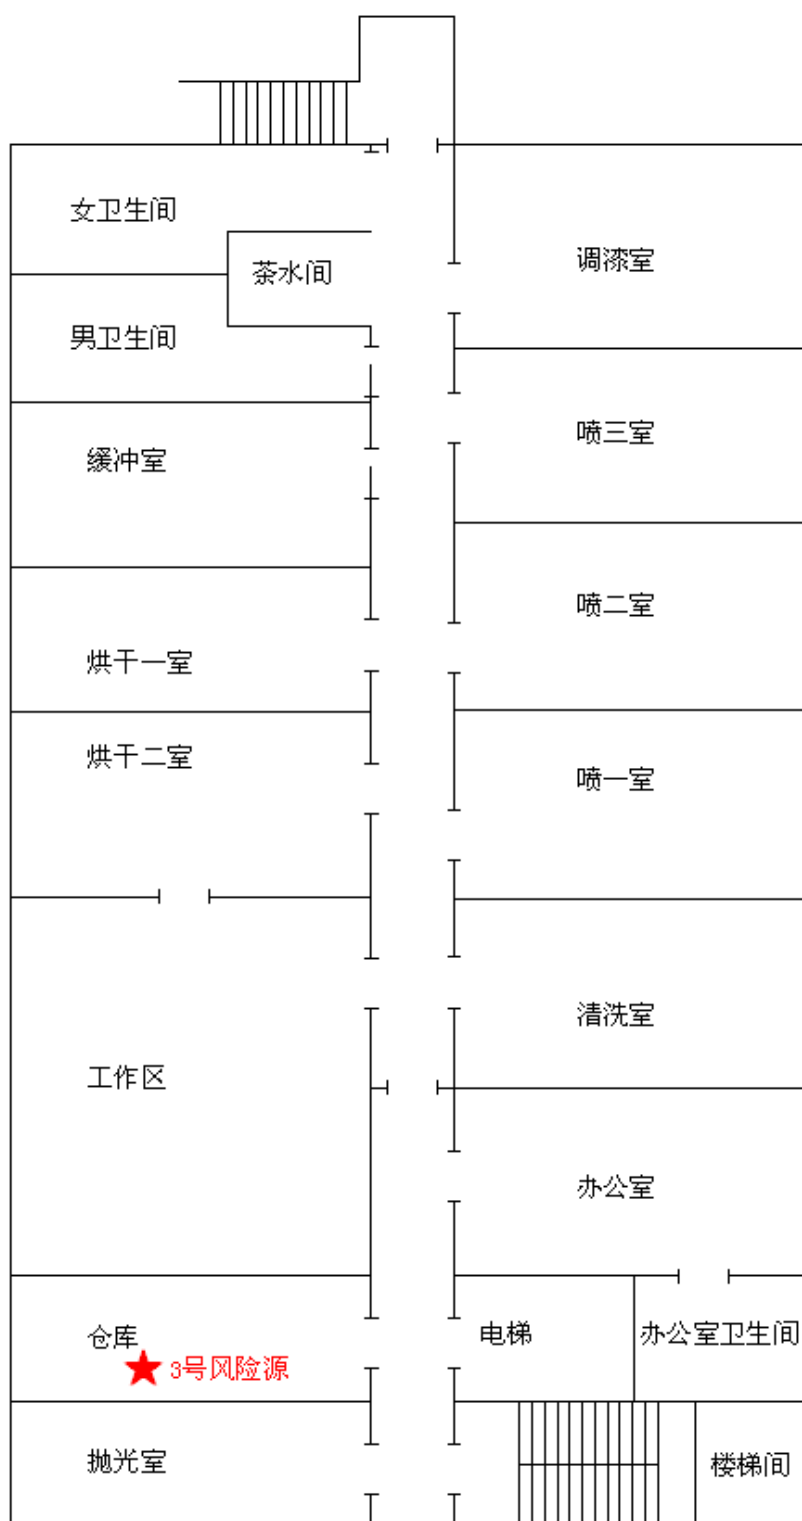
1#厂房 4F 喷漆车间平面布置图
